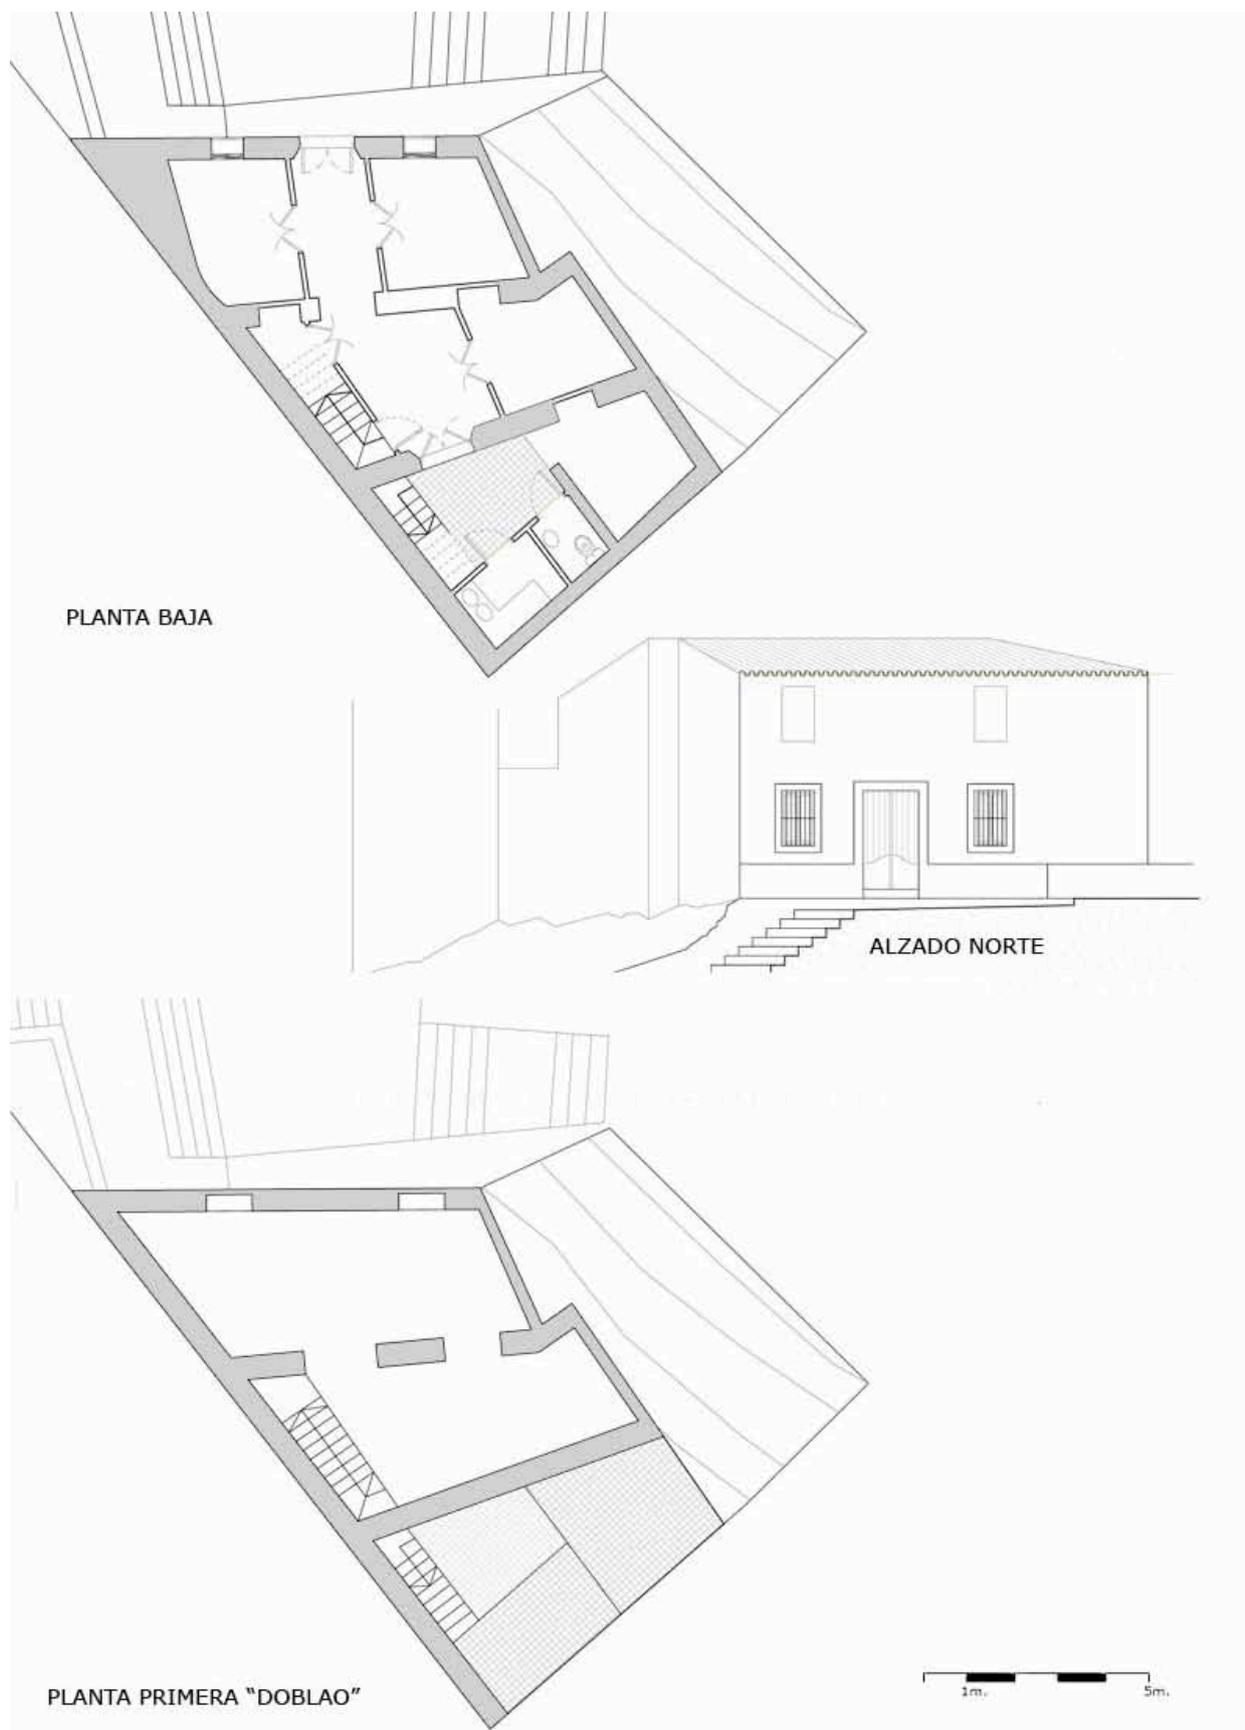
Planta Baja, "Doblao" y Alzado Norte del estado actual de la vivienda C/ Cuesta de la fuente 21 (Castuera)
